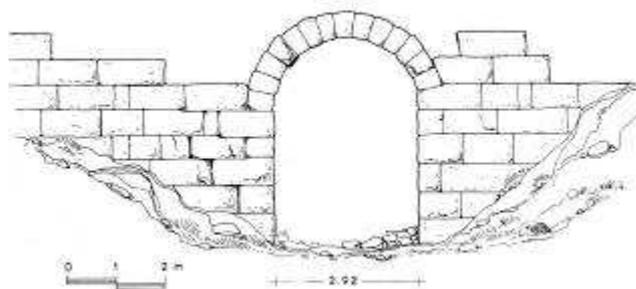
Eraclea al Latmo. Prospetto della porta sud della cinta difensiva (ADAM 1981)
